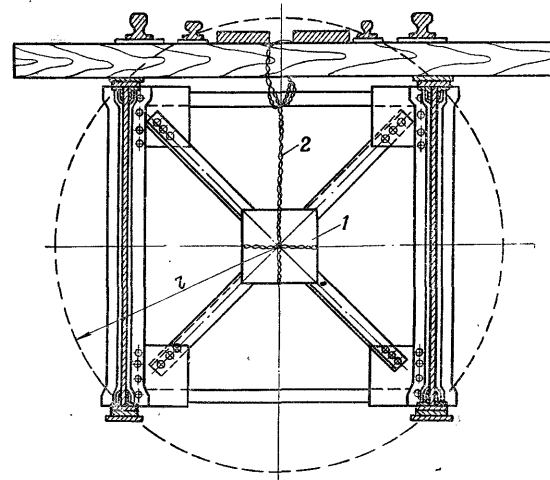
Подрывание неконтактными зарядами металлических пролетных строений со сплошными фермами:
